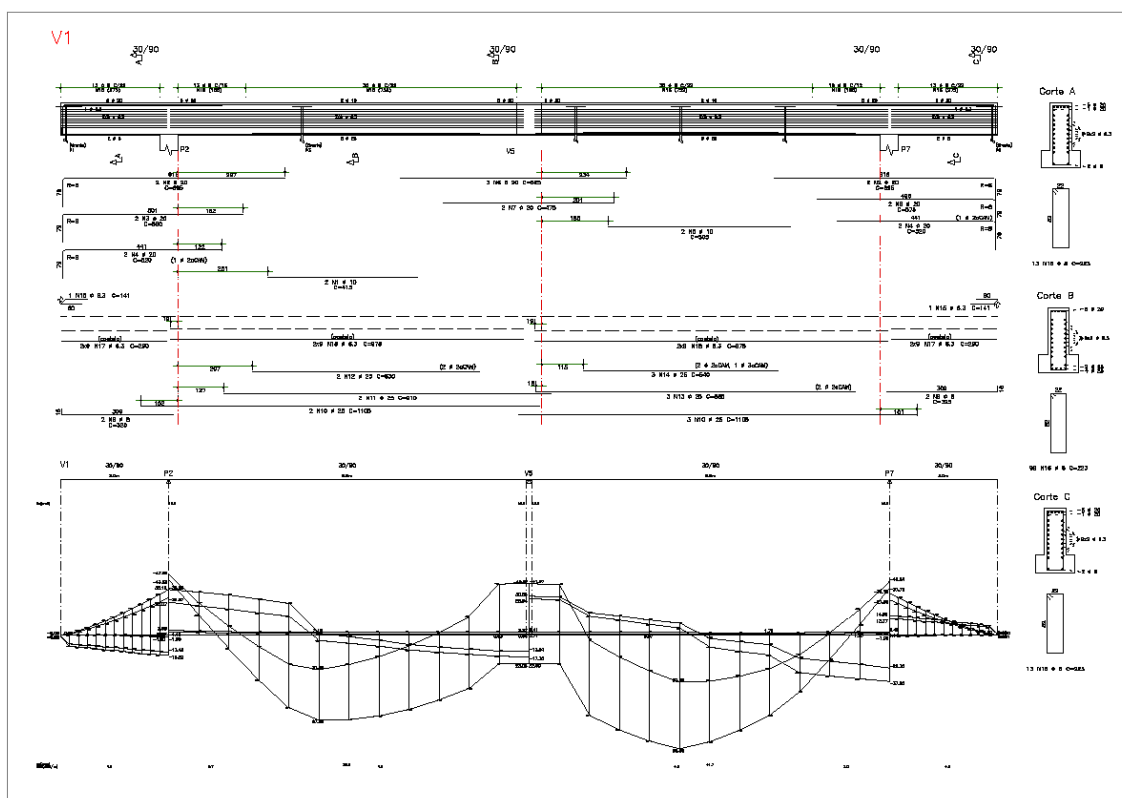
Cobertura: detalhamento da viga V1. Fonte: AUTOR (2017).
